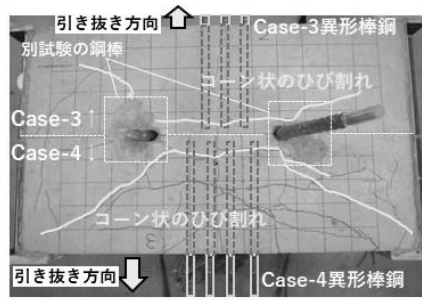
コンクリート表面のひび割れ (Case-3,4(写真-5,6の供試体を上から撮影))
